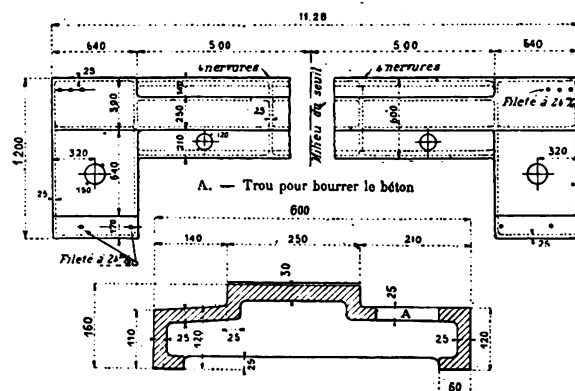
Coupe transversale d'un seuil en fonte sur lequel s'appuie chaque vanne; A, trou pour boucher le béton.
